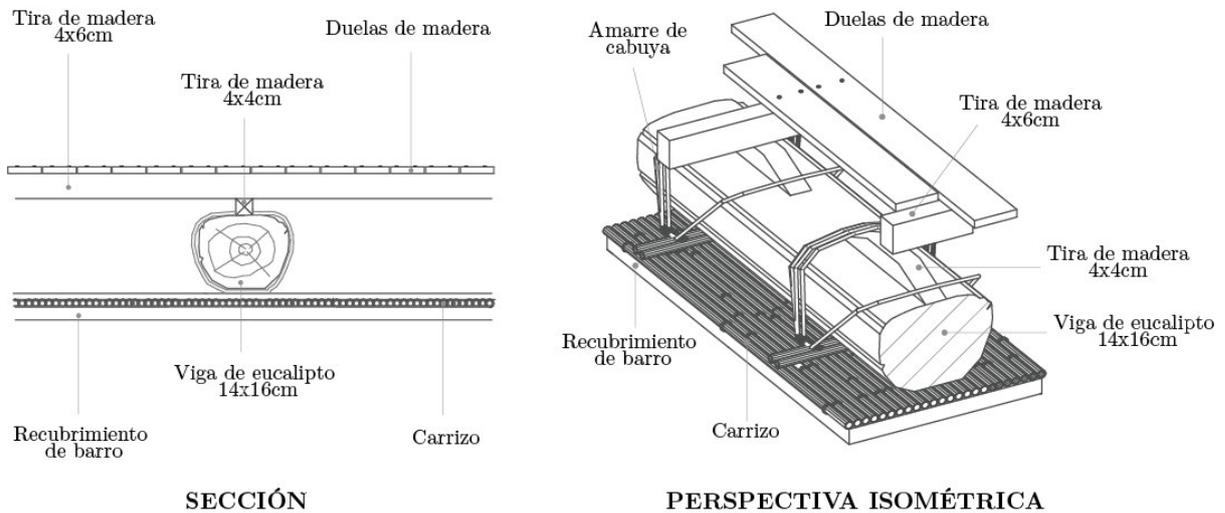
Detalle constructivo cielo raso de carrizo con barro
